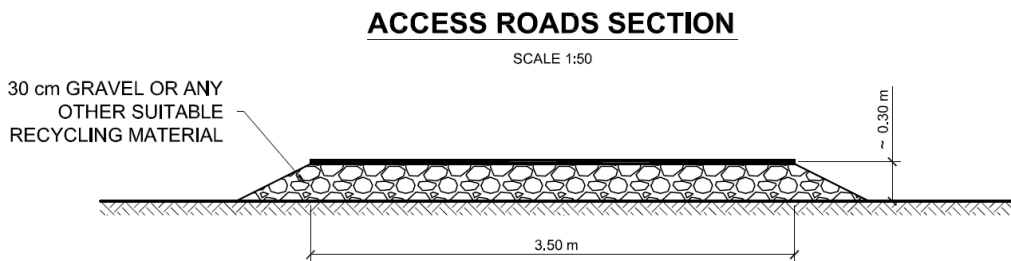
SECCIÓN DE LAS CARRETERAS DE ACCESO
